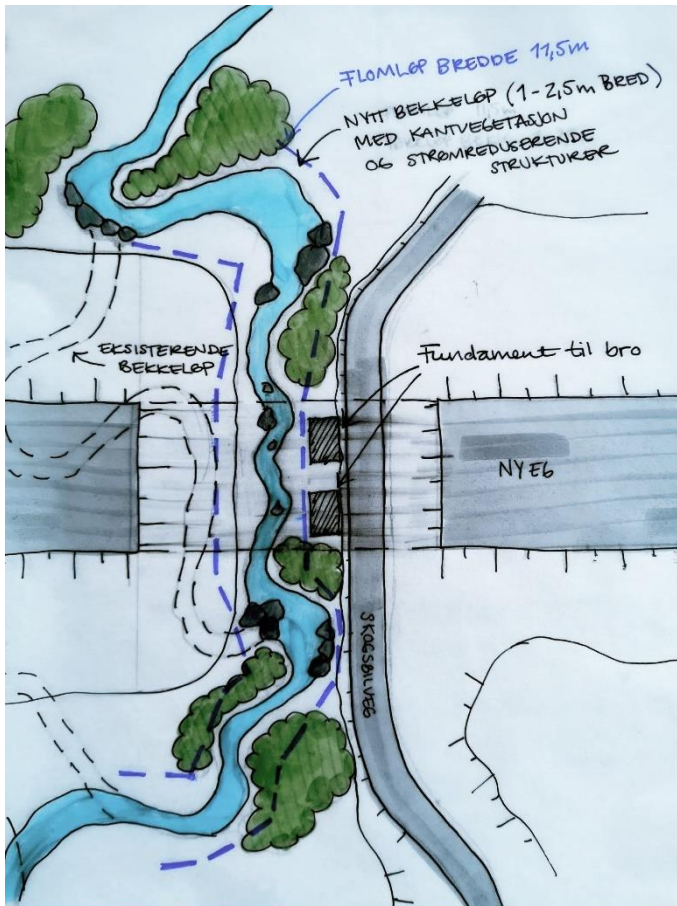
Tegning av planlagt bru over Krokbecken som viser eksisterende bekkeløp og nytt bekkeløp. Lokalvei vil gå til høyre for nytt bekkeløp. Kilde: Rambøll.
